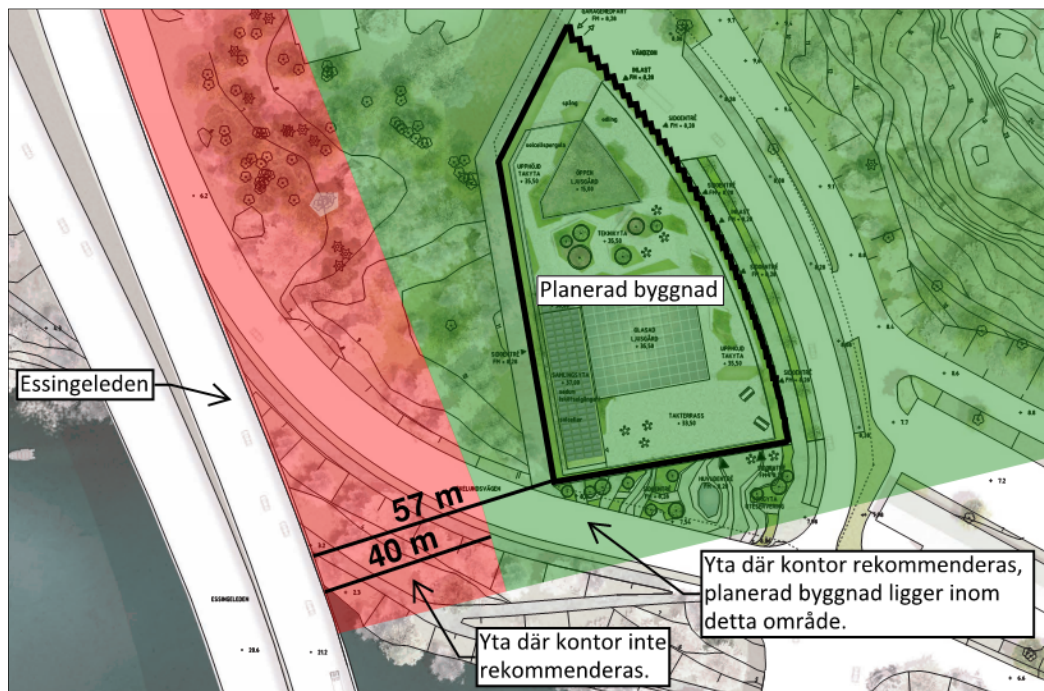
Planerad byggnad och avstånd till Essingeleden.
